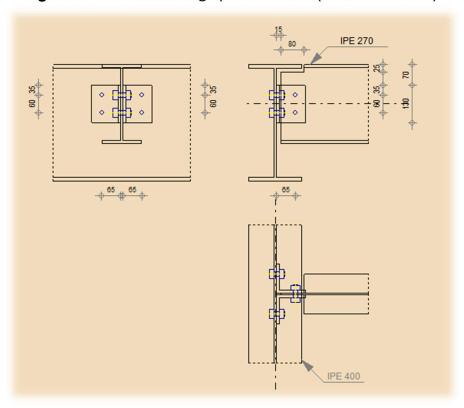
Détail d'assemblage poutre-solive (IPE400-IPE270)
